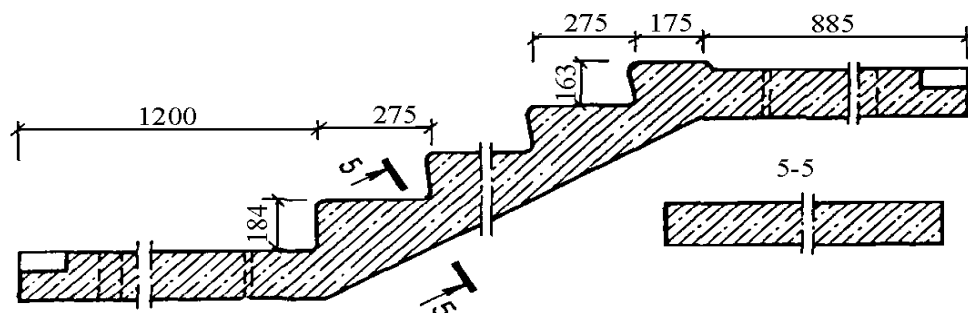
Конструктивные решения железобетонных сборных лестниц из крупных элементов
